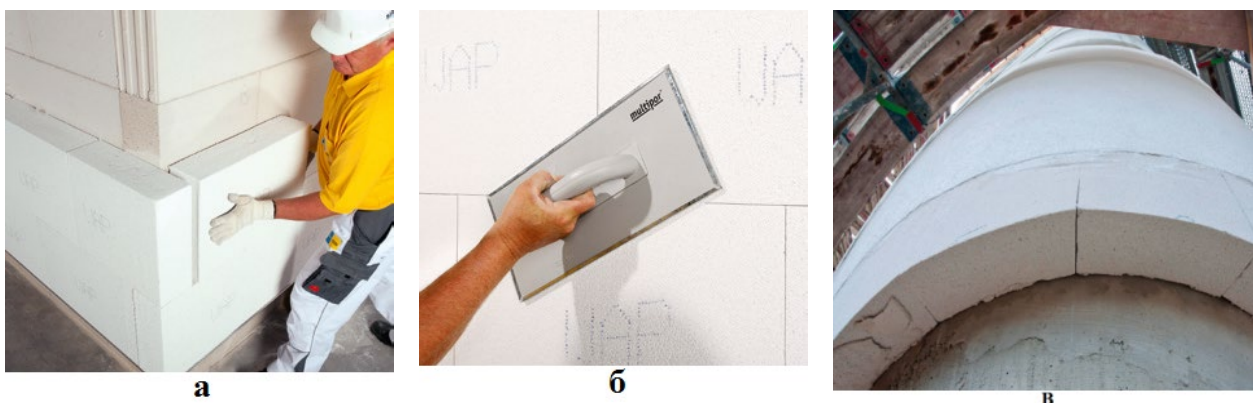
Монтаж плит: а — сдвиг плит на углу здания; б — выравнивание поверхности; в — выпуклая поверхность фасада
